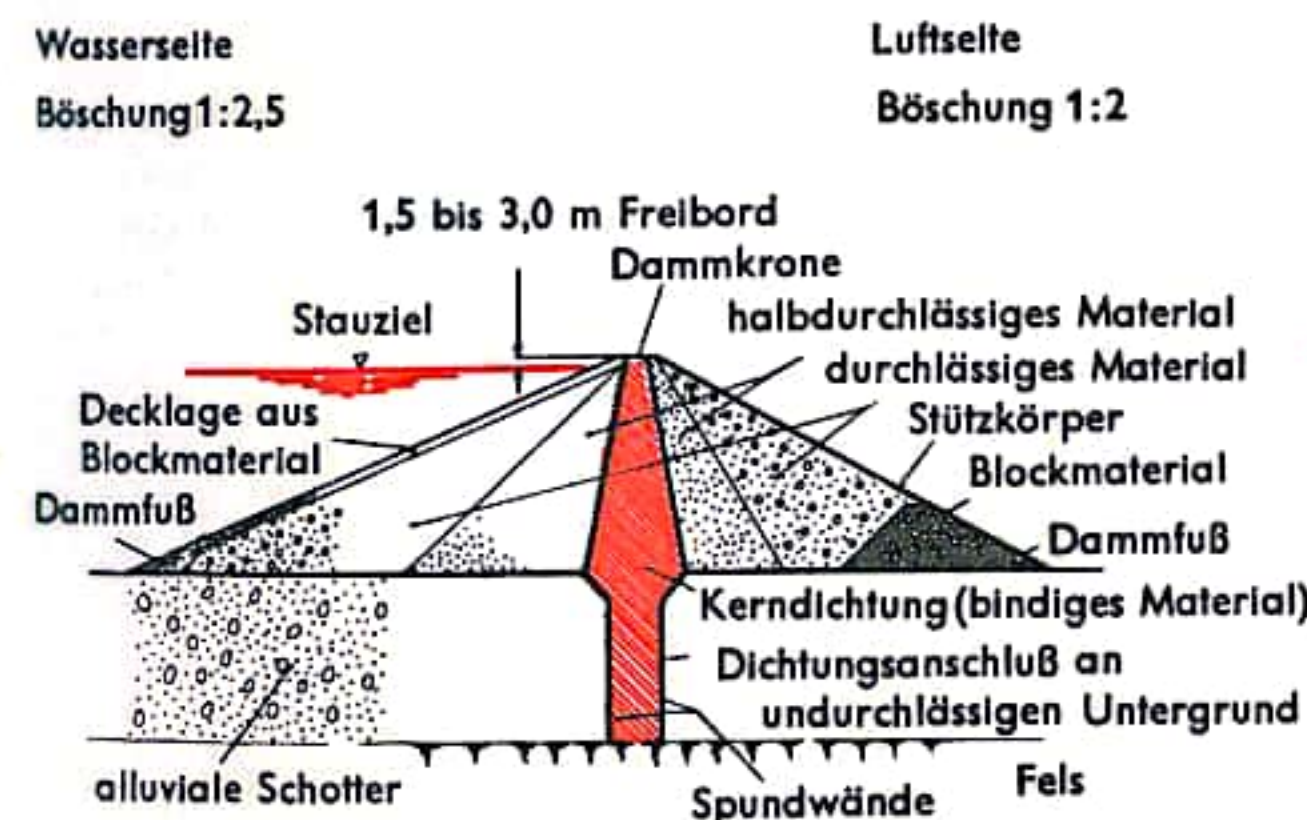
Geschütteter Erddamm mit Kerndichtung
